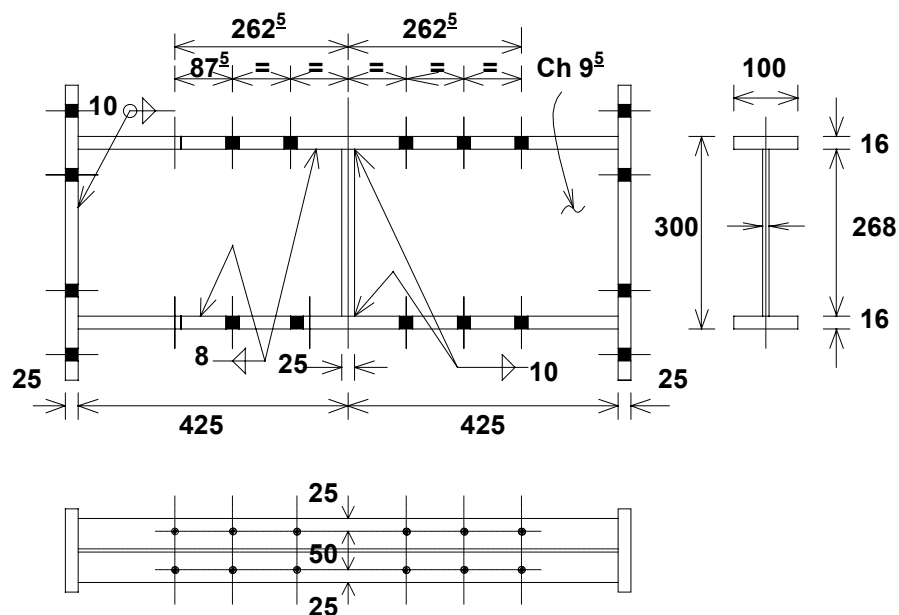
Detalhamento das vigas dos pórticos de apoio dos protótipos
